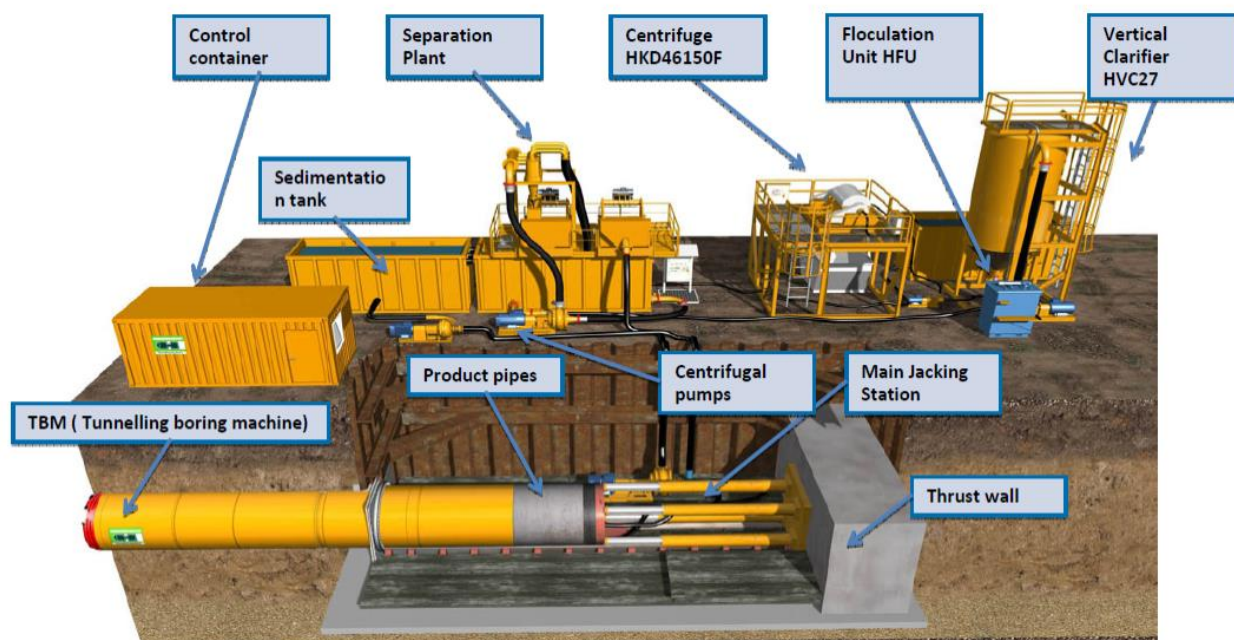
B : Schema tipo cantiere microtunnelling pozzo di spinta
